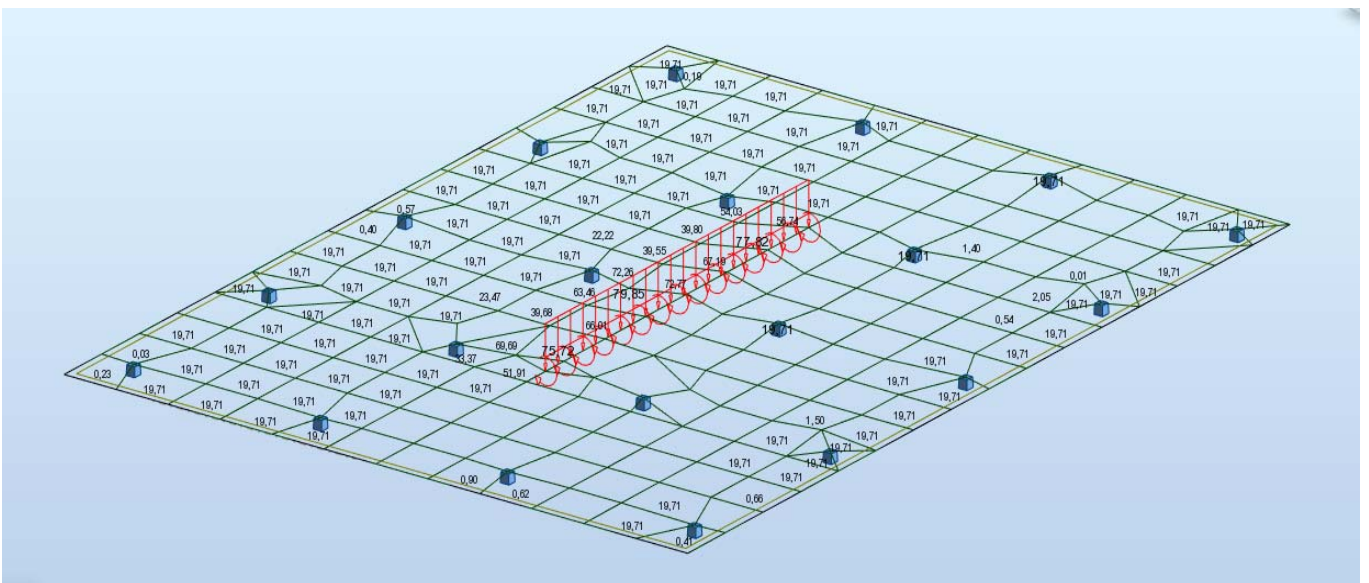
Ferrailage de la semelle en mètre linéaire
